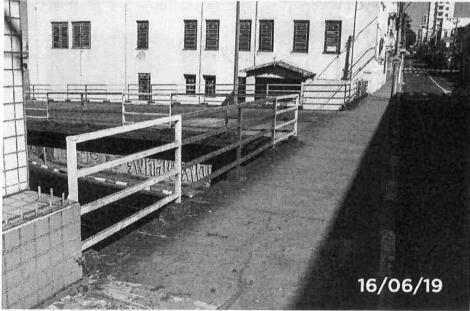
Vista dos pontos de corrosão, vegetação no bloco de apoio com o passeio.
